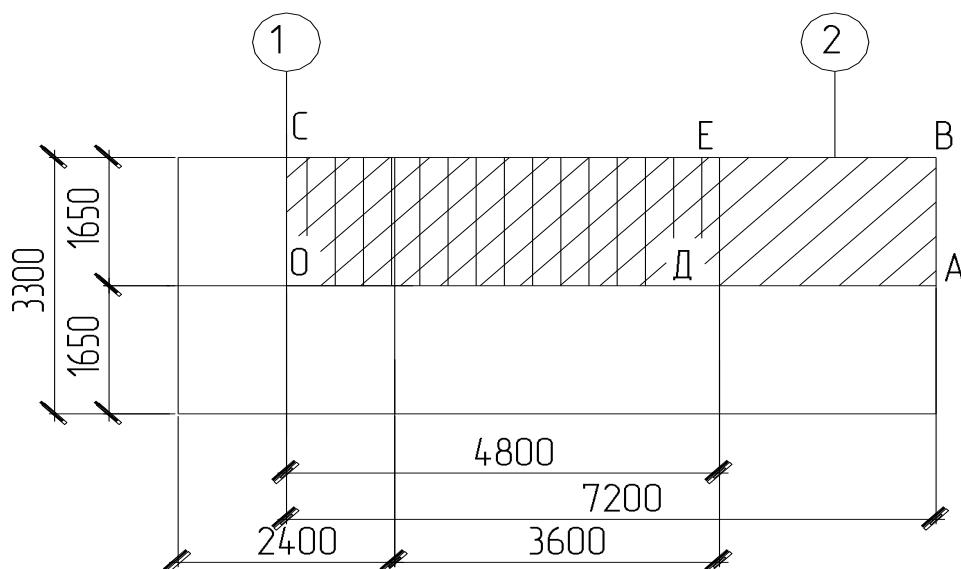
Расчётная схема определение вертикальных нормальных напряжений и расчета осадки фундамента с учетом влияния соседнего фундамента, к примеру 4.5
